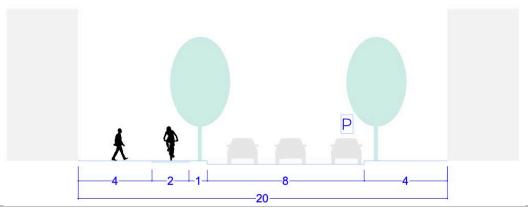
Sección de calle a escala urbana. Cotas en metros lineales (m)
